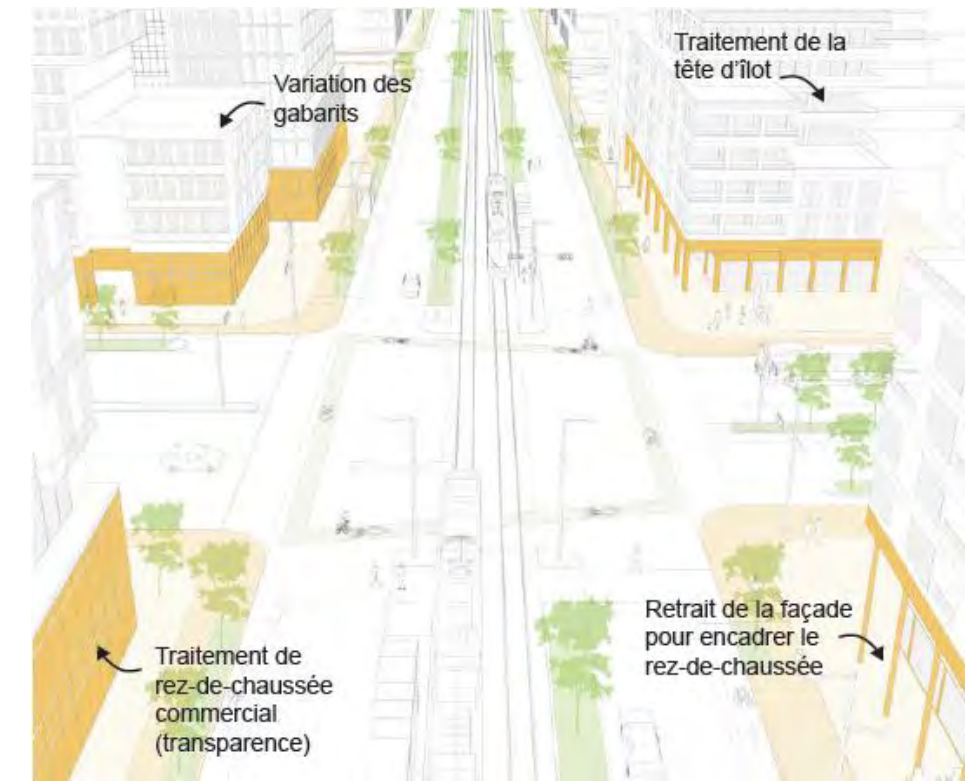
Traitement architectural à l'intersection de boulevards
